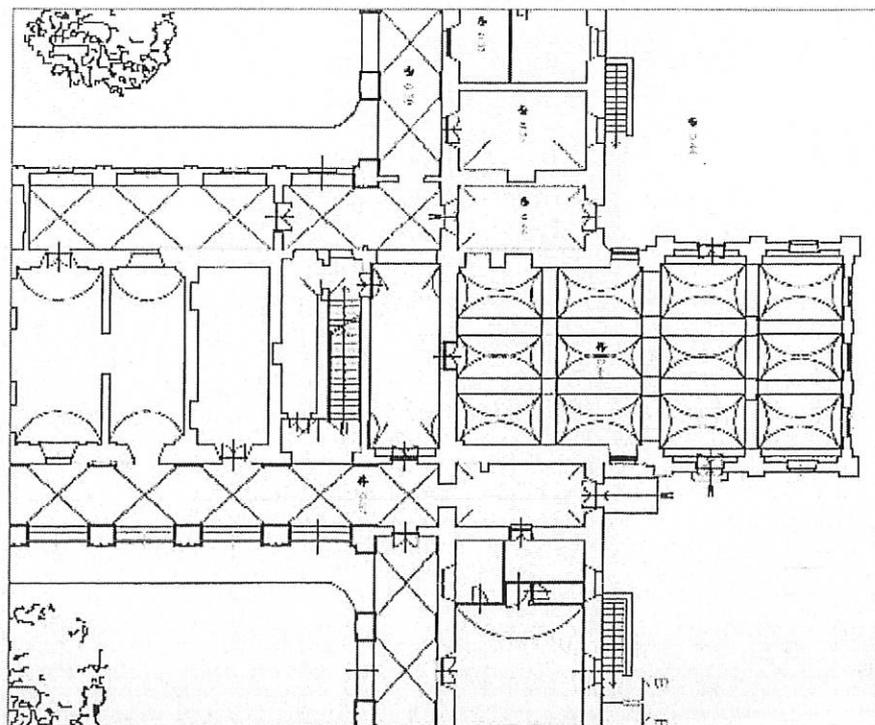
Pianta attuale a p.t. dell'avancorpo a sud
